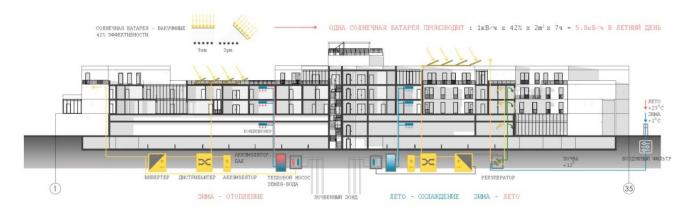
Энергия / отопление / охлаждение / вентиляция
